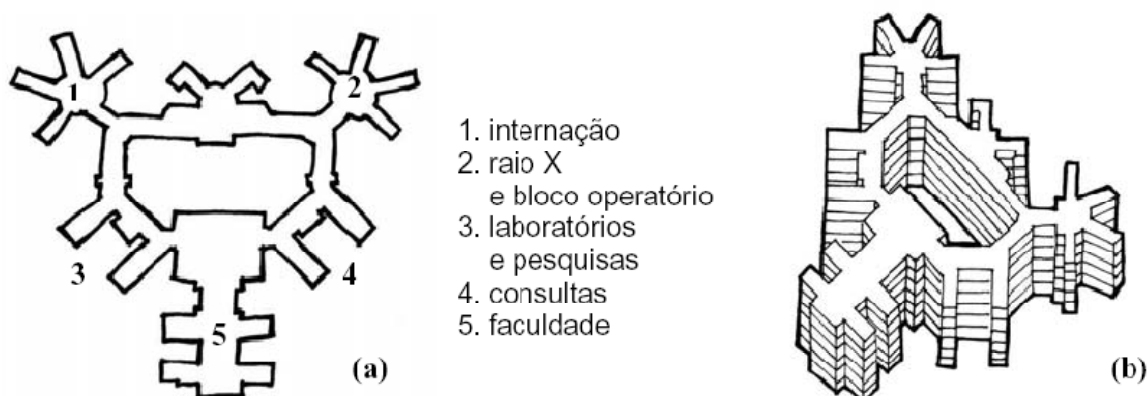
Cite Hospitalière, Lille, 1932. (a) planta; (b) croqui.
